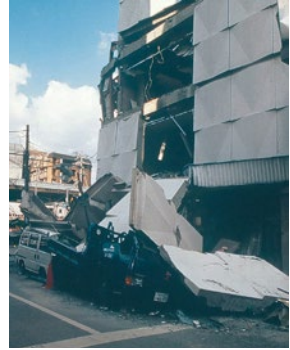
und 4b: Heruntergefallene Fassadenelemente, Kobe 1995. Foto 4a: Architectural Institute of Japan, Foto 4b: T. Wenk, SGEB-Erkundungsmission
